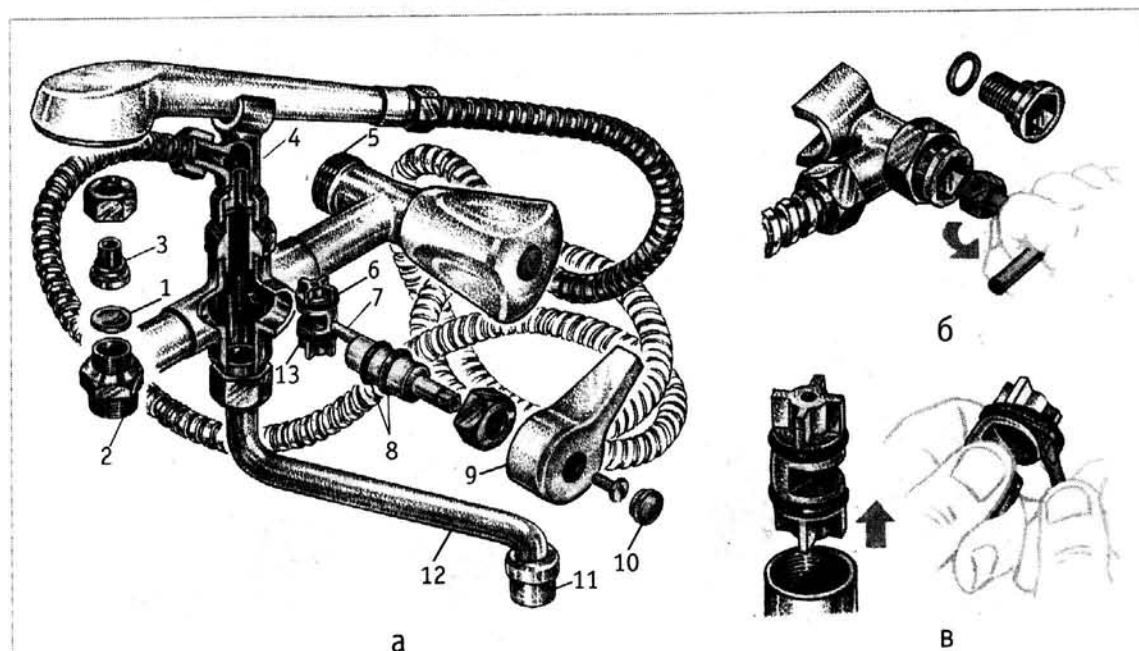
Смеситель с золотниковым переключателем, подставкой и золотником, имеющим резиновые кольца: а — детали смесителя; б — затяжка штуцера; в — удаление изношенного резинового кольца;
